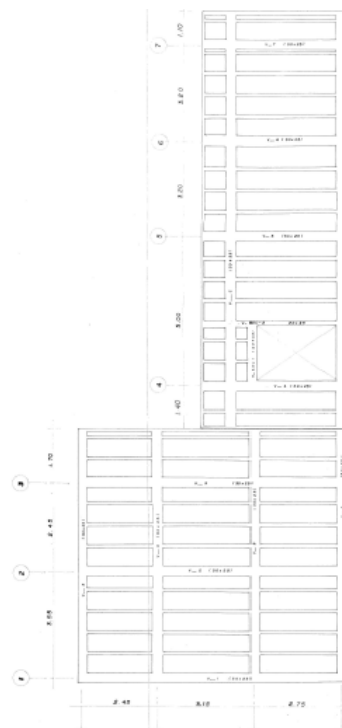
Planta Cubierta. Edificio Plaza Libertador Artes y Oficios.
